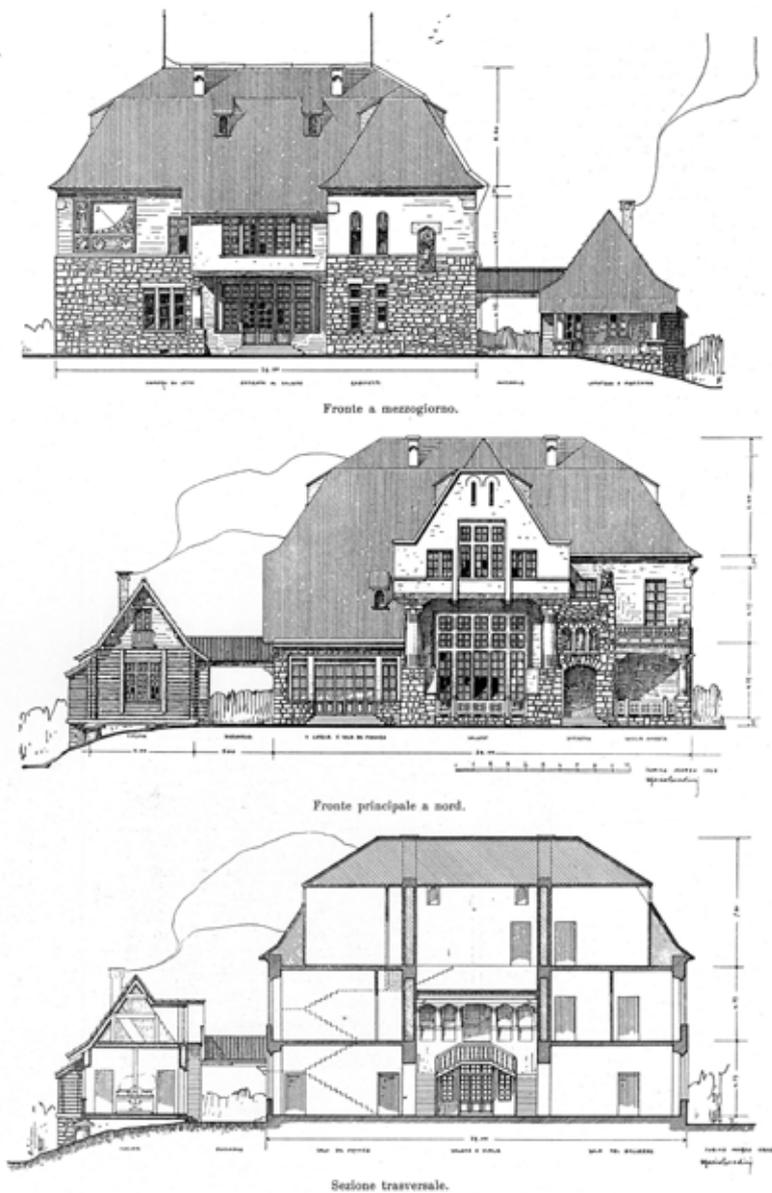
Villa La Montanina. *Cottage*: facciate (sud e nord) e sezione trasversale.
